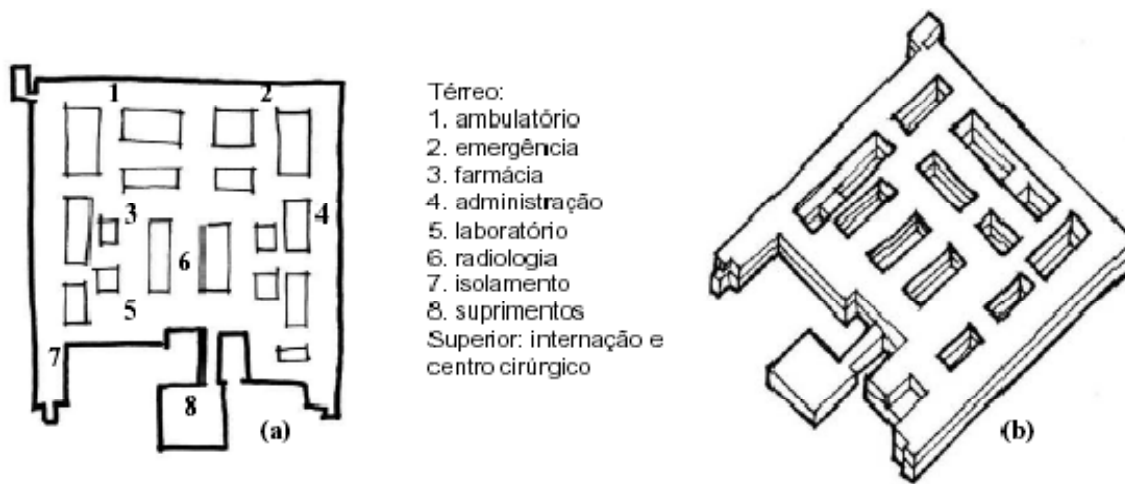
Best Buy Hospital, Bury St Edmunds, 1967. (a) planta; (b) croqui.
